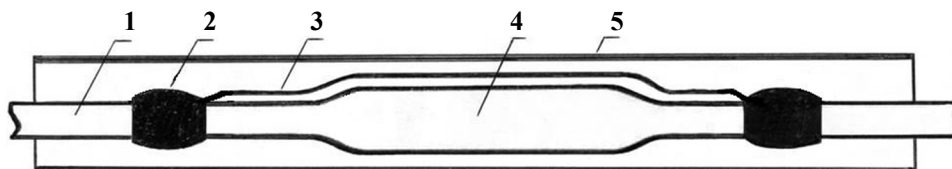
Подготовка наружной трубки ТУТ к усадке:
